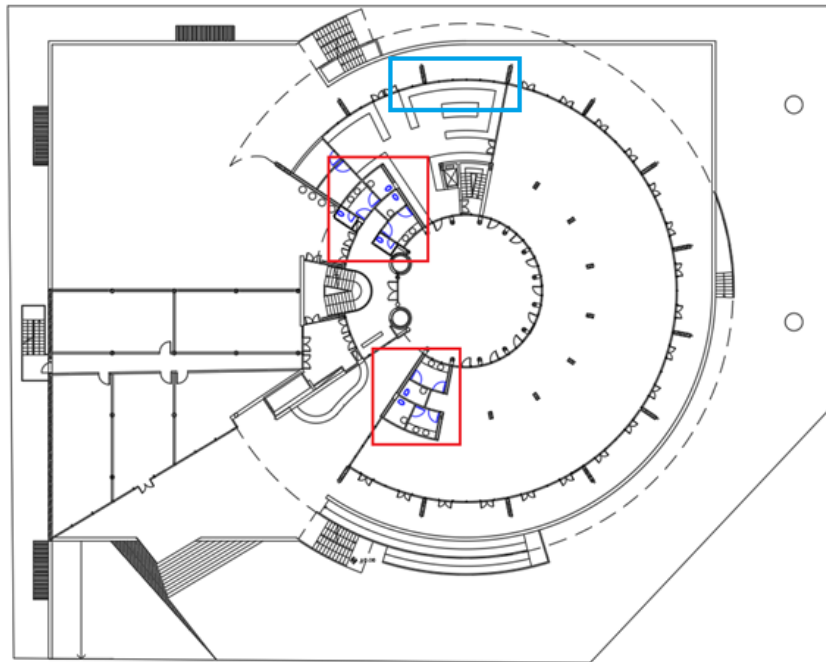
Ubicación de los locales húmedos en la planta baja.
